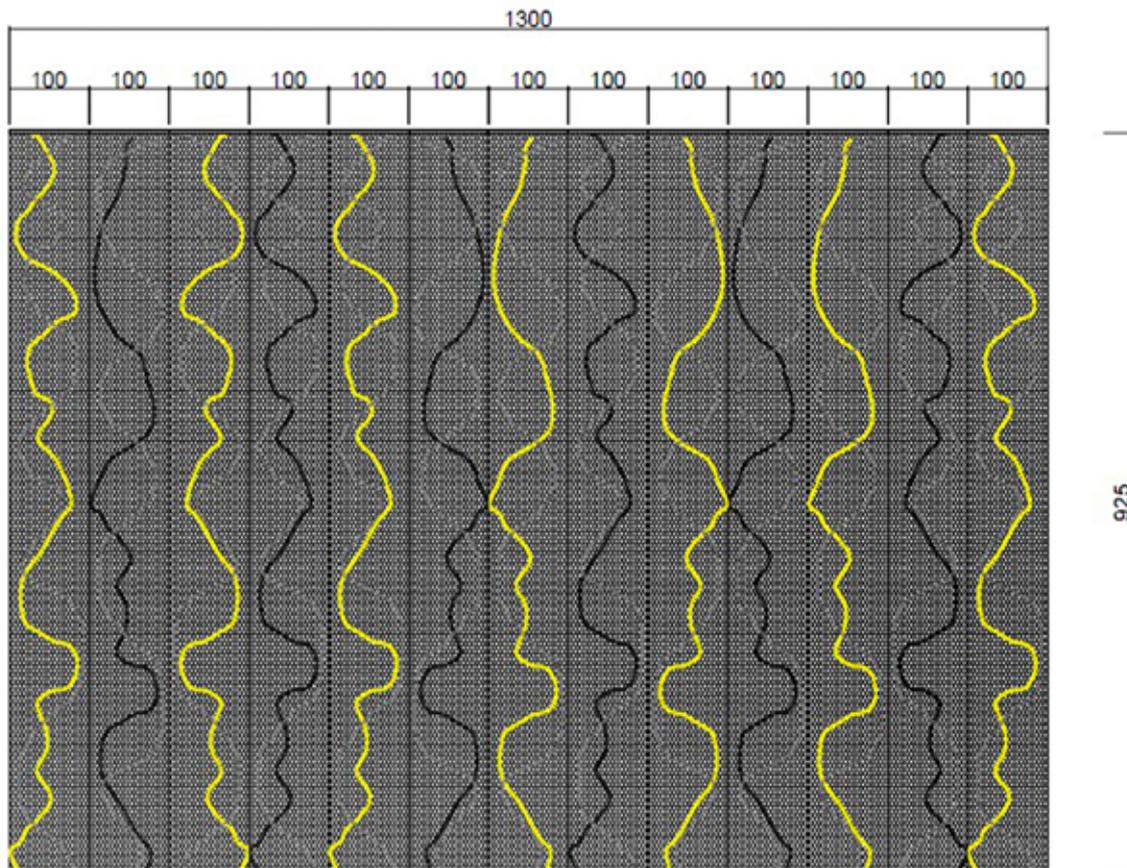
Planta baixa, em software AutoCad 2007, mostrando a cobertura que o teto ficaria com as 13 faixas de telas de 1 metro x 9,25 metros. Fonte: Stefanello Studio.
